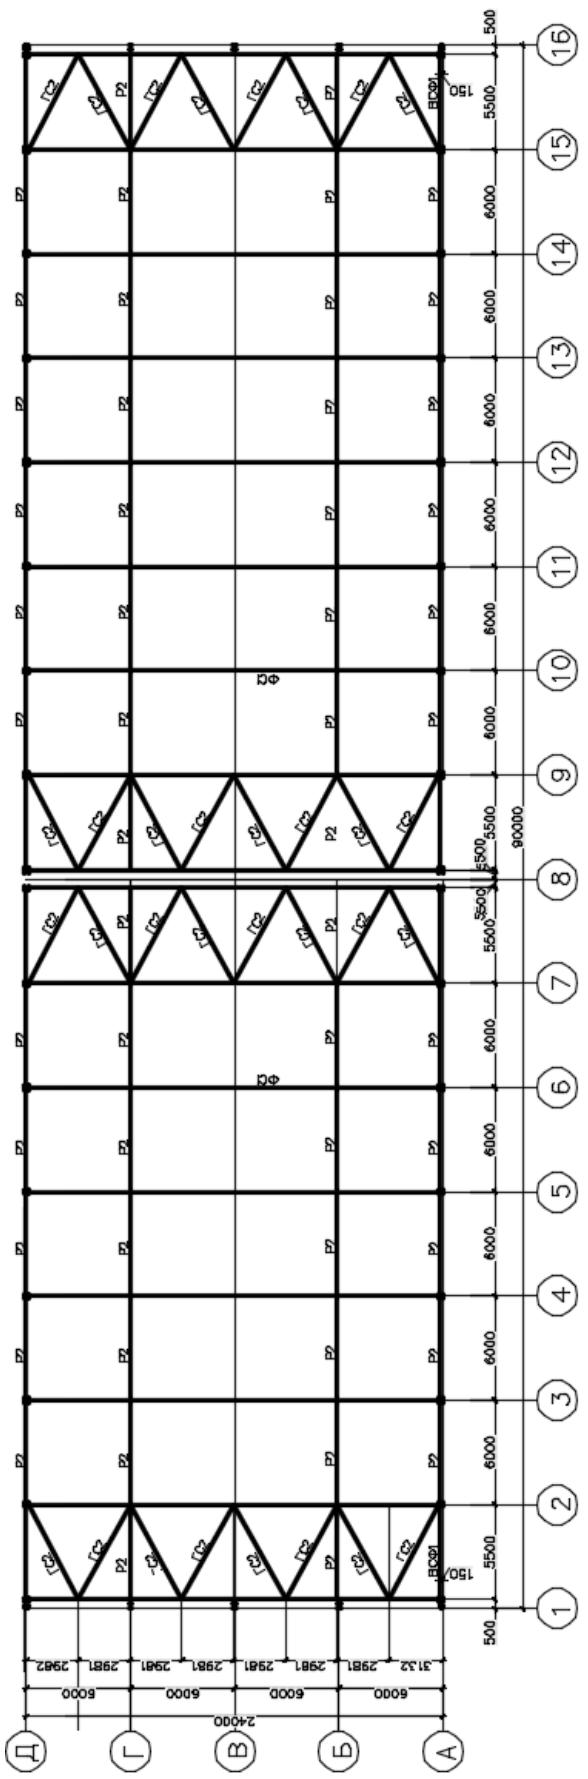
Схемы связей по верхним поясам стропильных ферм
